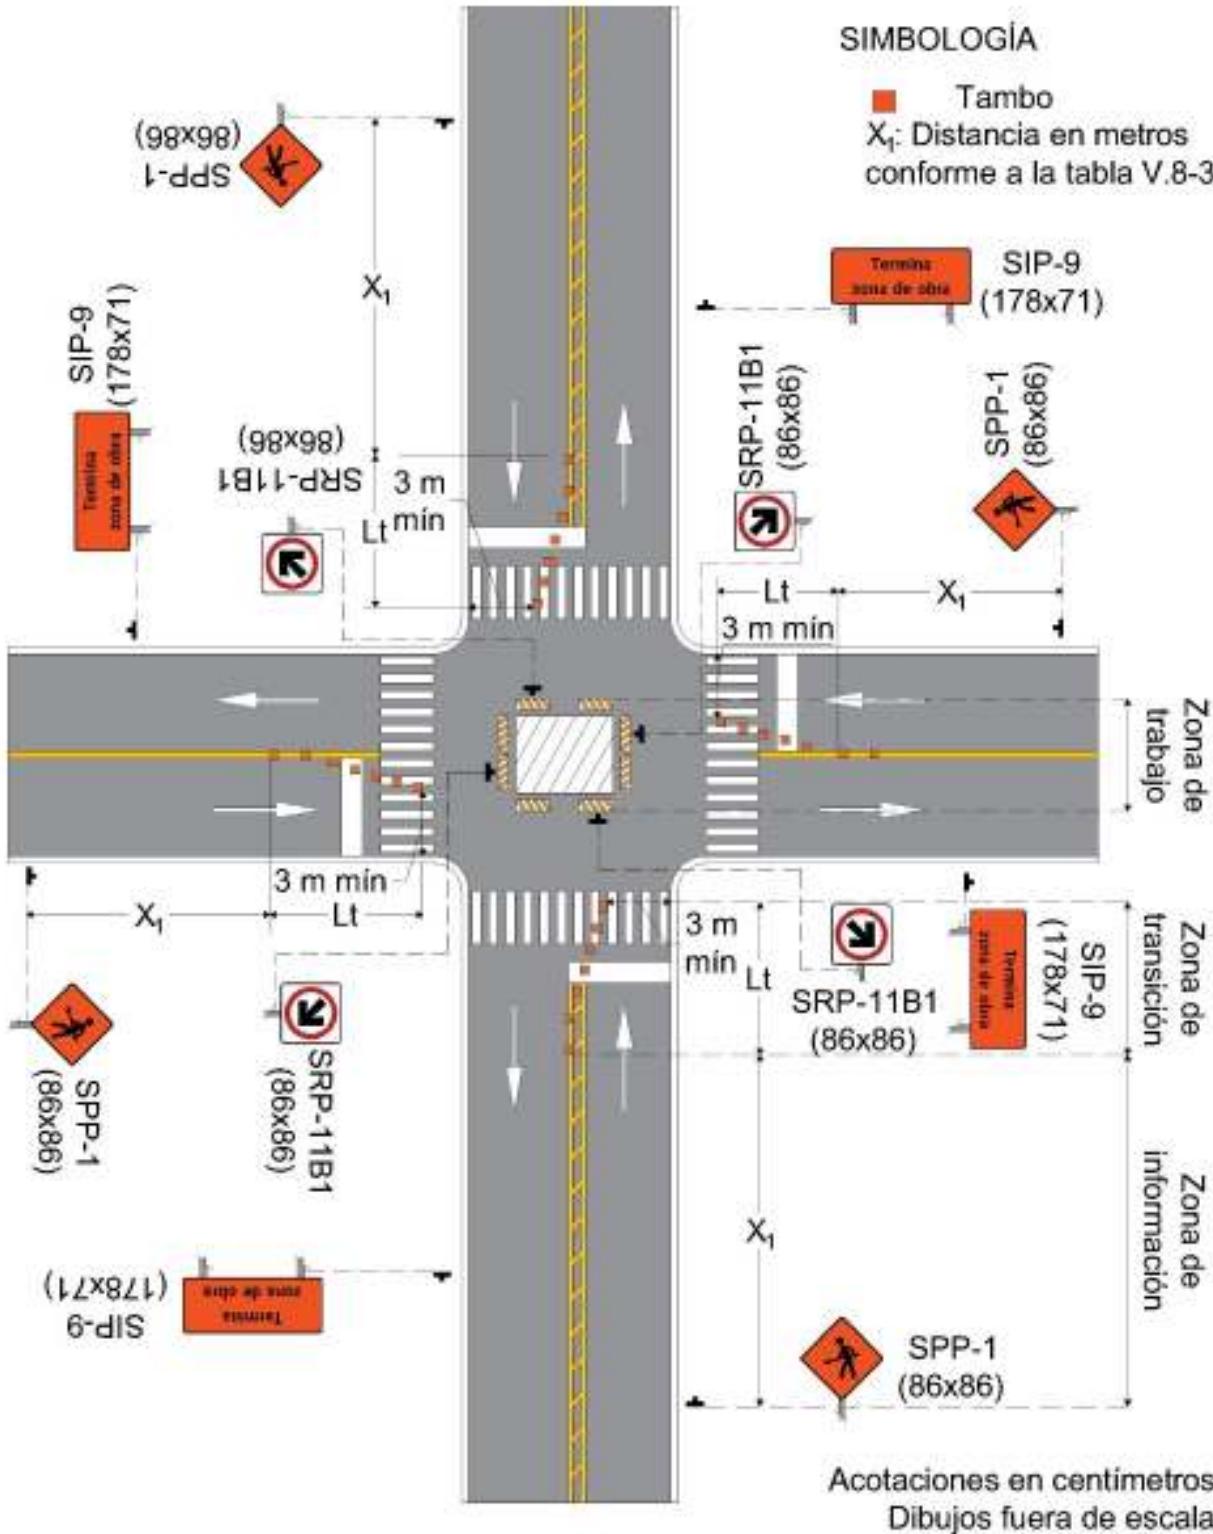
Cierres de carriles en el centro de una intersección (Vía con ancho de arroyo vial menor a 9 m)
